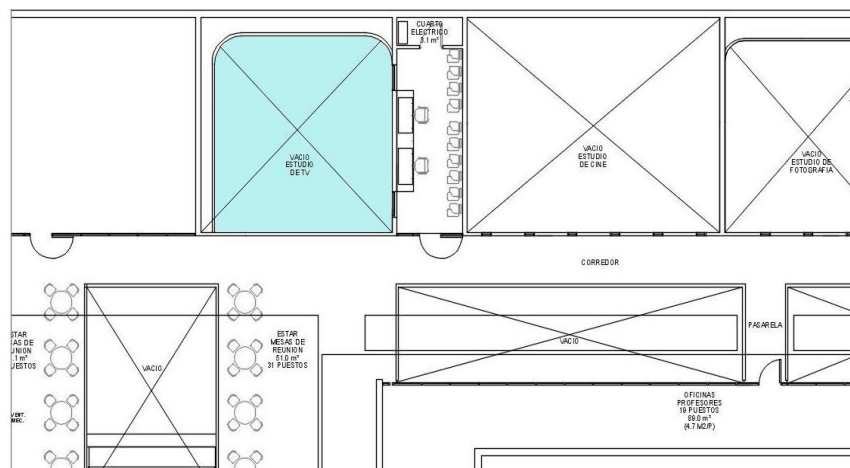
Plano arquitectónico. Estudio de Televisión en Planta Alta
